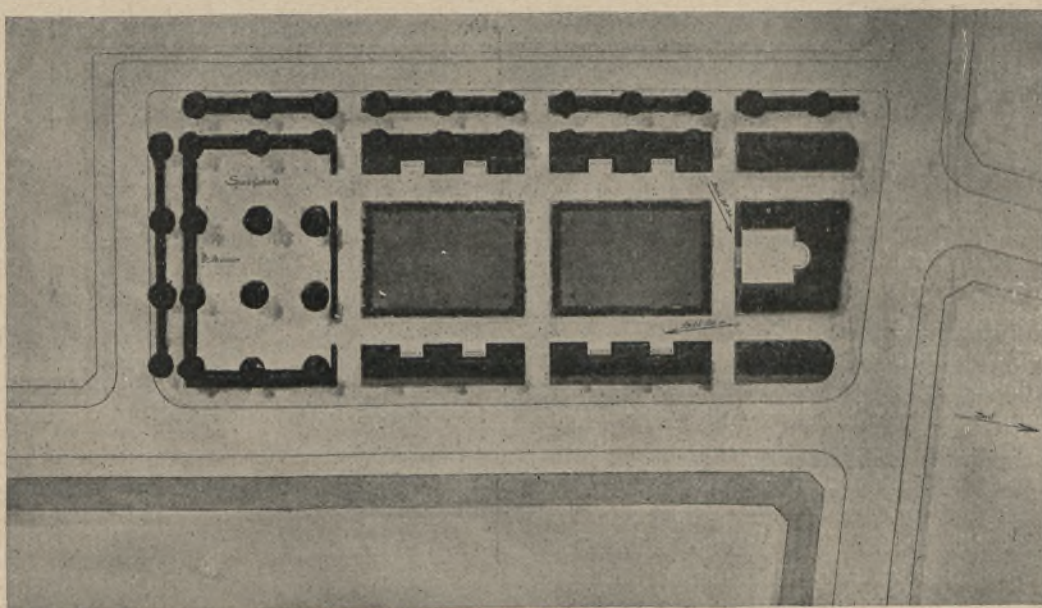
Lortzingpark in Cöln a. Rh. Lageplan. Gartenbaudirektor Encke.
